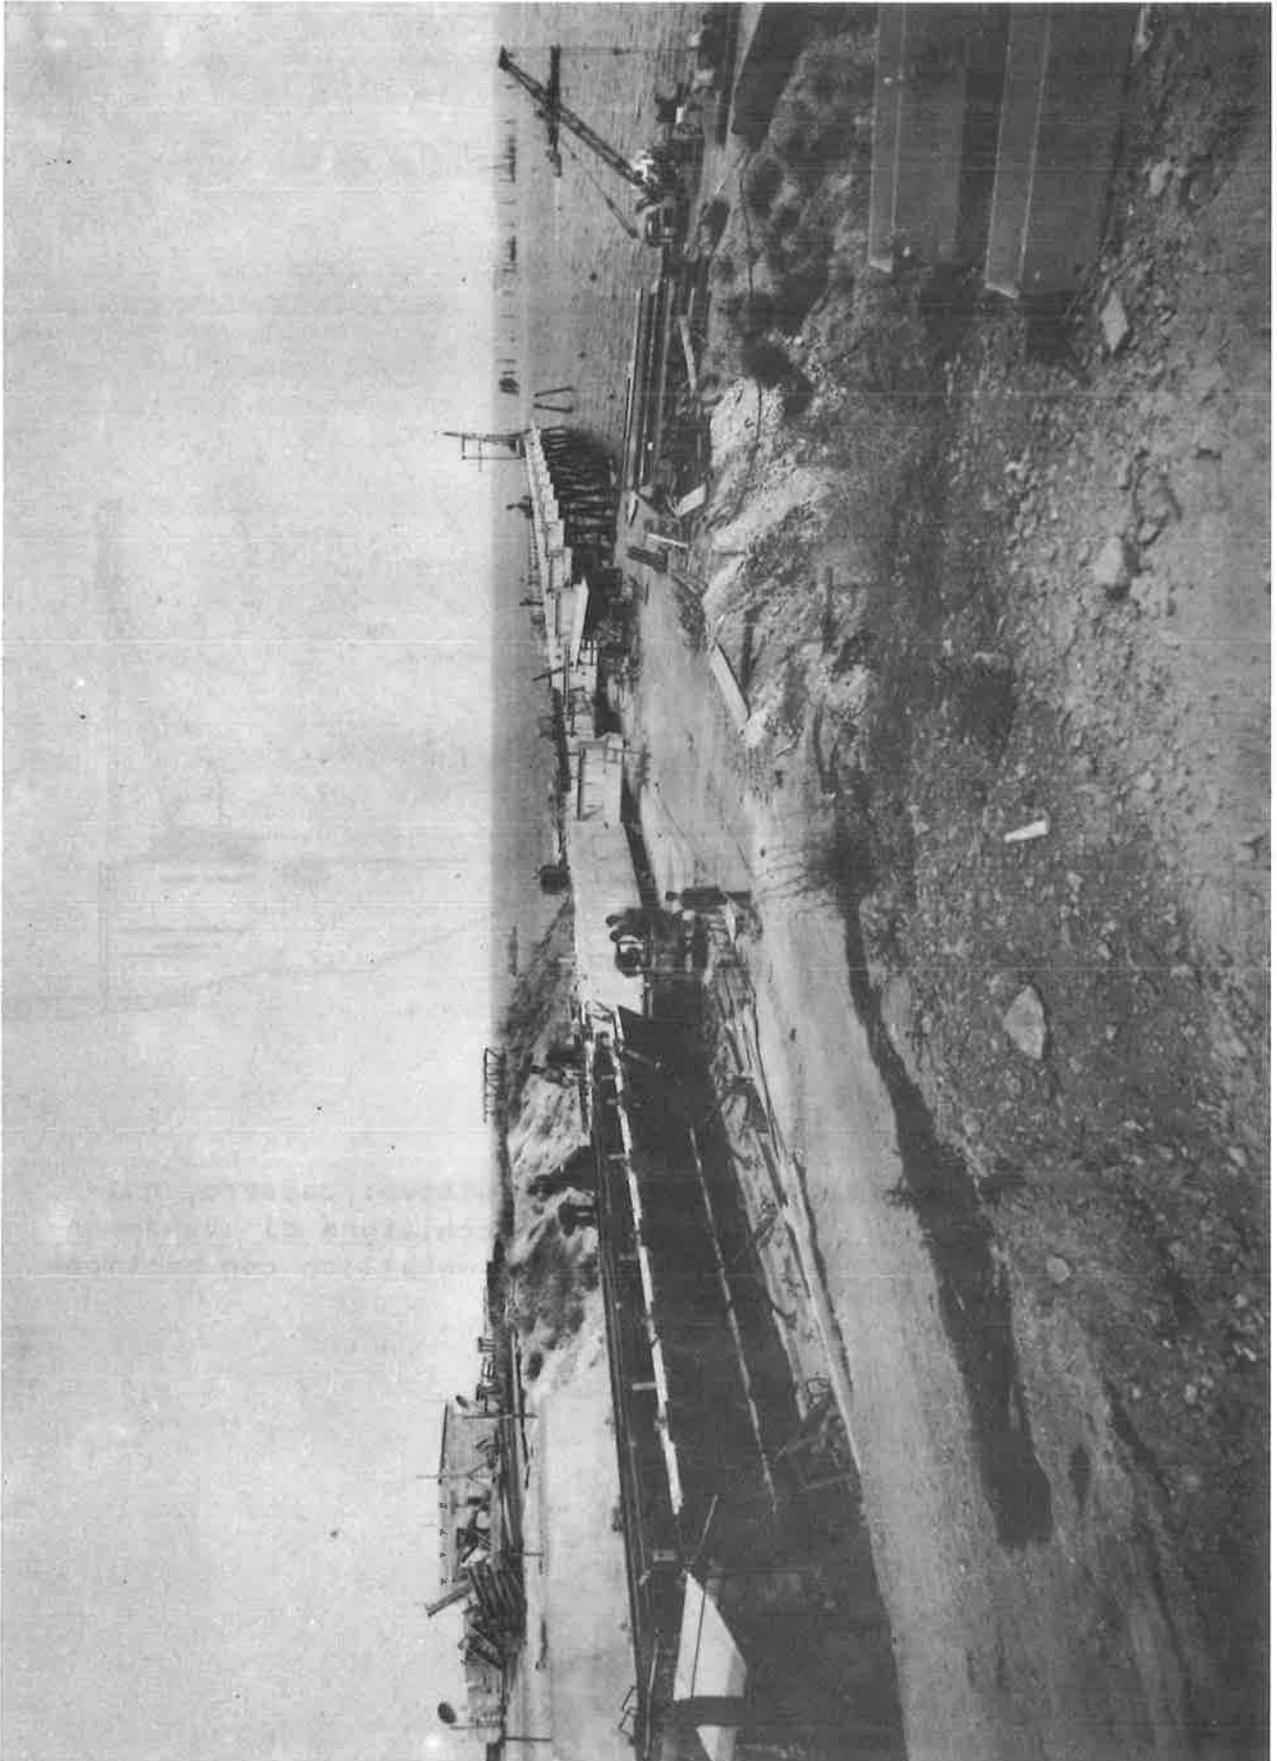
Pontile SARAS - Il cantiere di produzione dei tronchi precompressi
